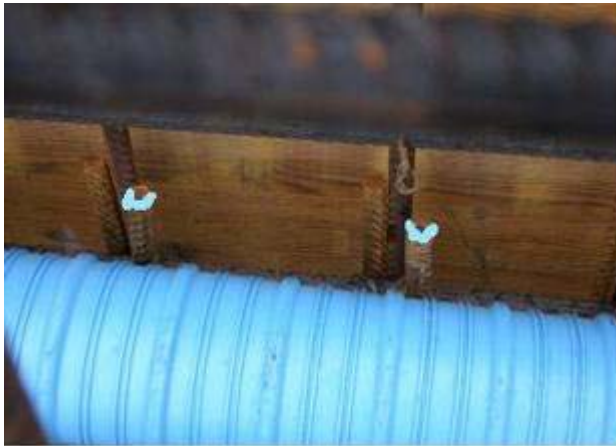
Hüllrohr beim Einbau durch scharfe Kanten an stehenden Bewehrungsstäben beschädigt (abgetragenes Hüllrohrmaterial ist an der Bewehrung sichtbar).
